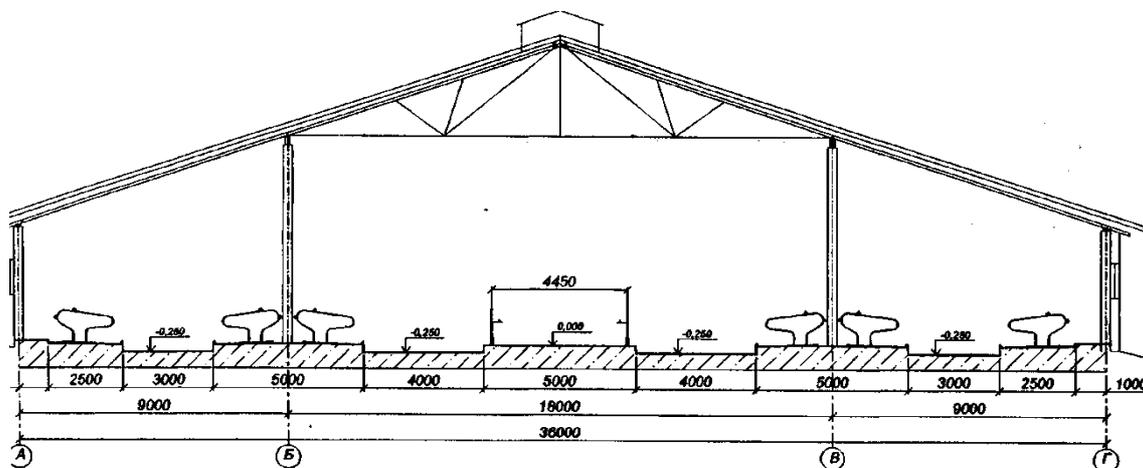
Широкогабаритный коровник из металлических конструкций
